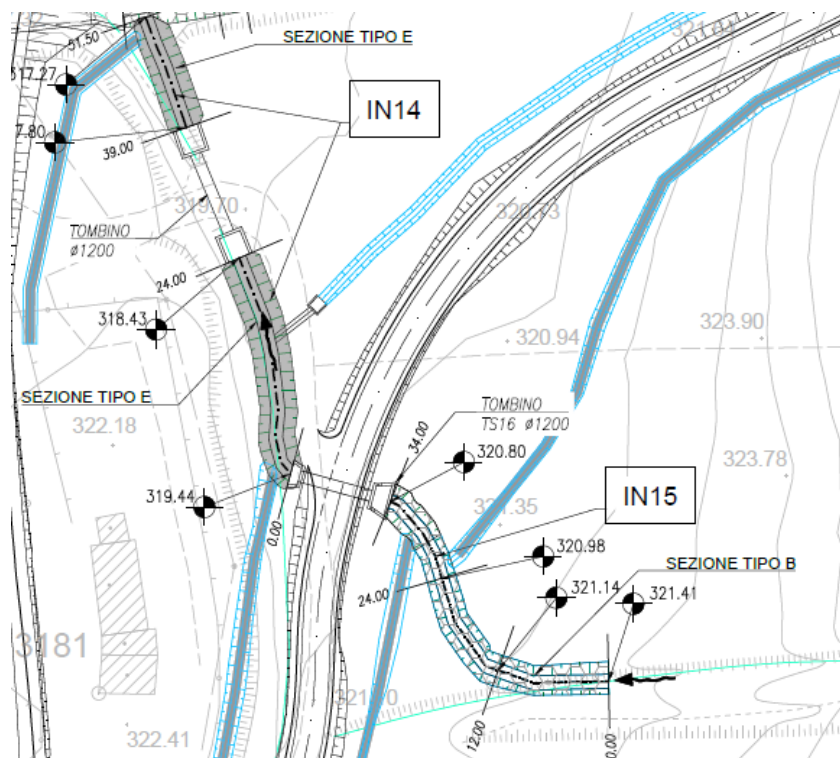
Stralcio planimetria SF25- particolare inalveazioni con adeguamento tombini
